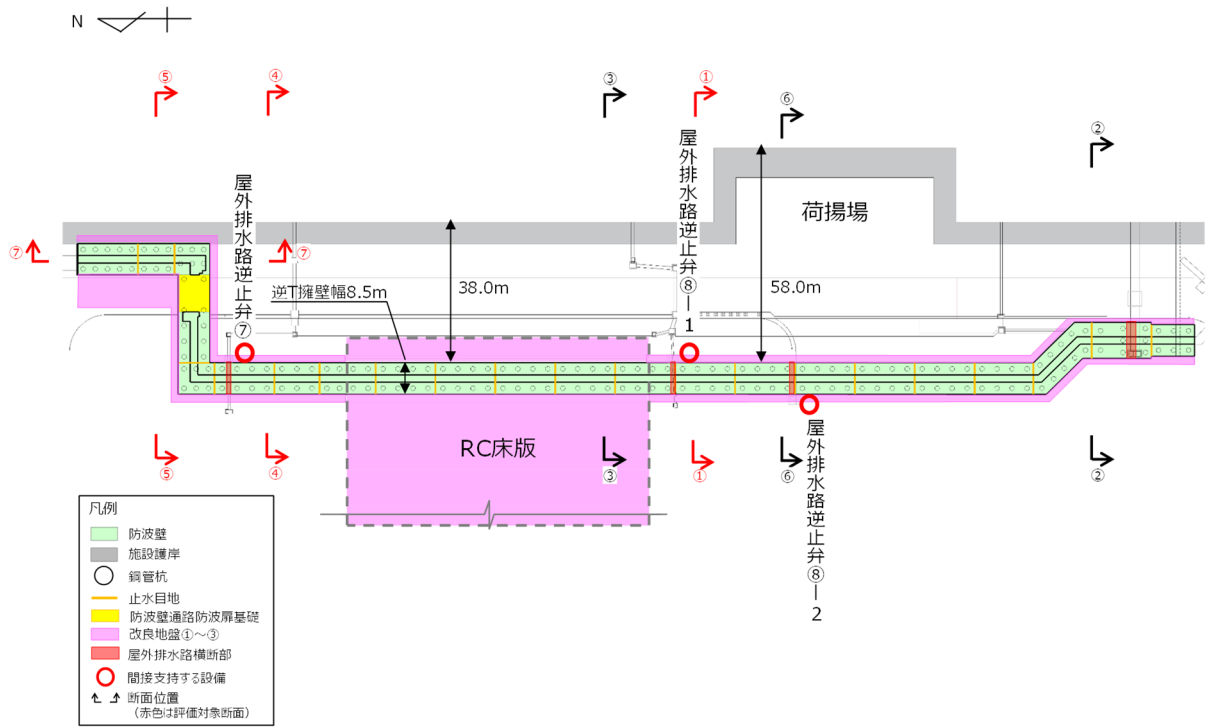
防波壁（逆 T 擁壁）平面配置図
